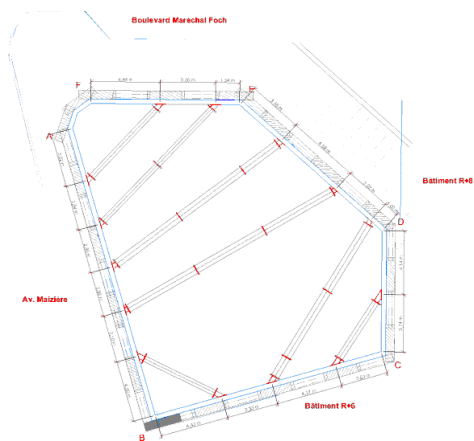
Planta da estrutura da contenção e escoramento horizontal da obra May Flower
